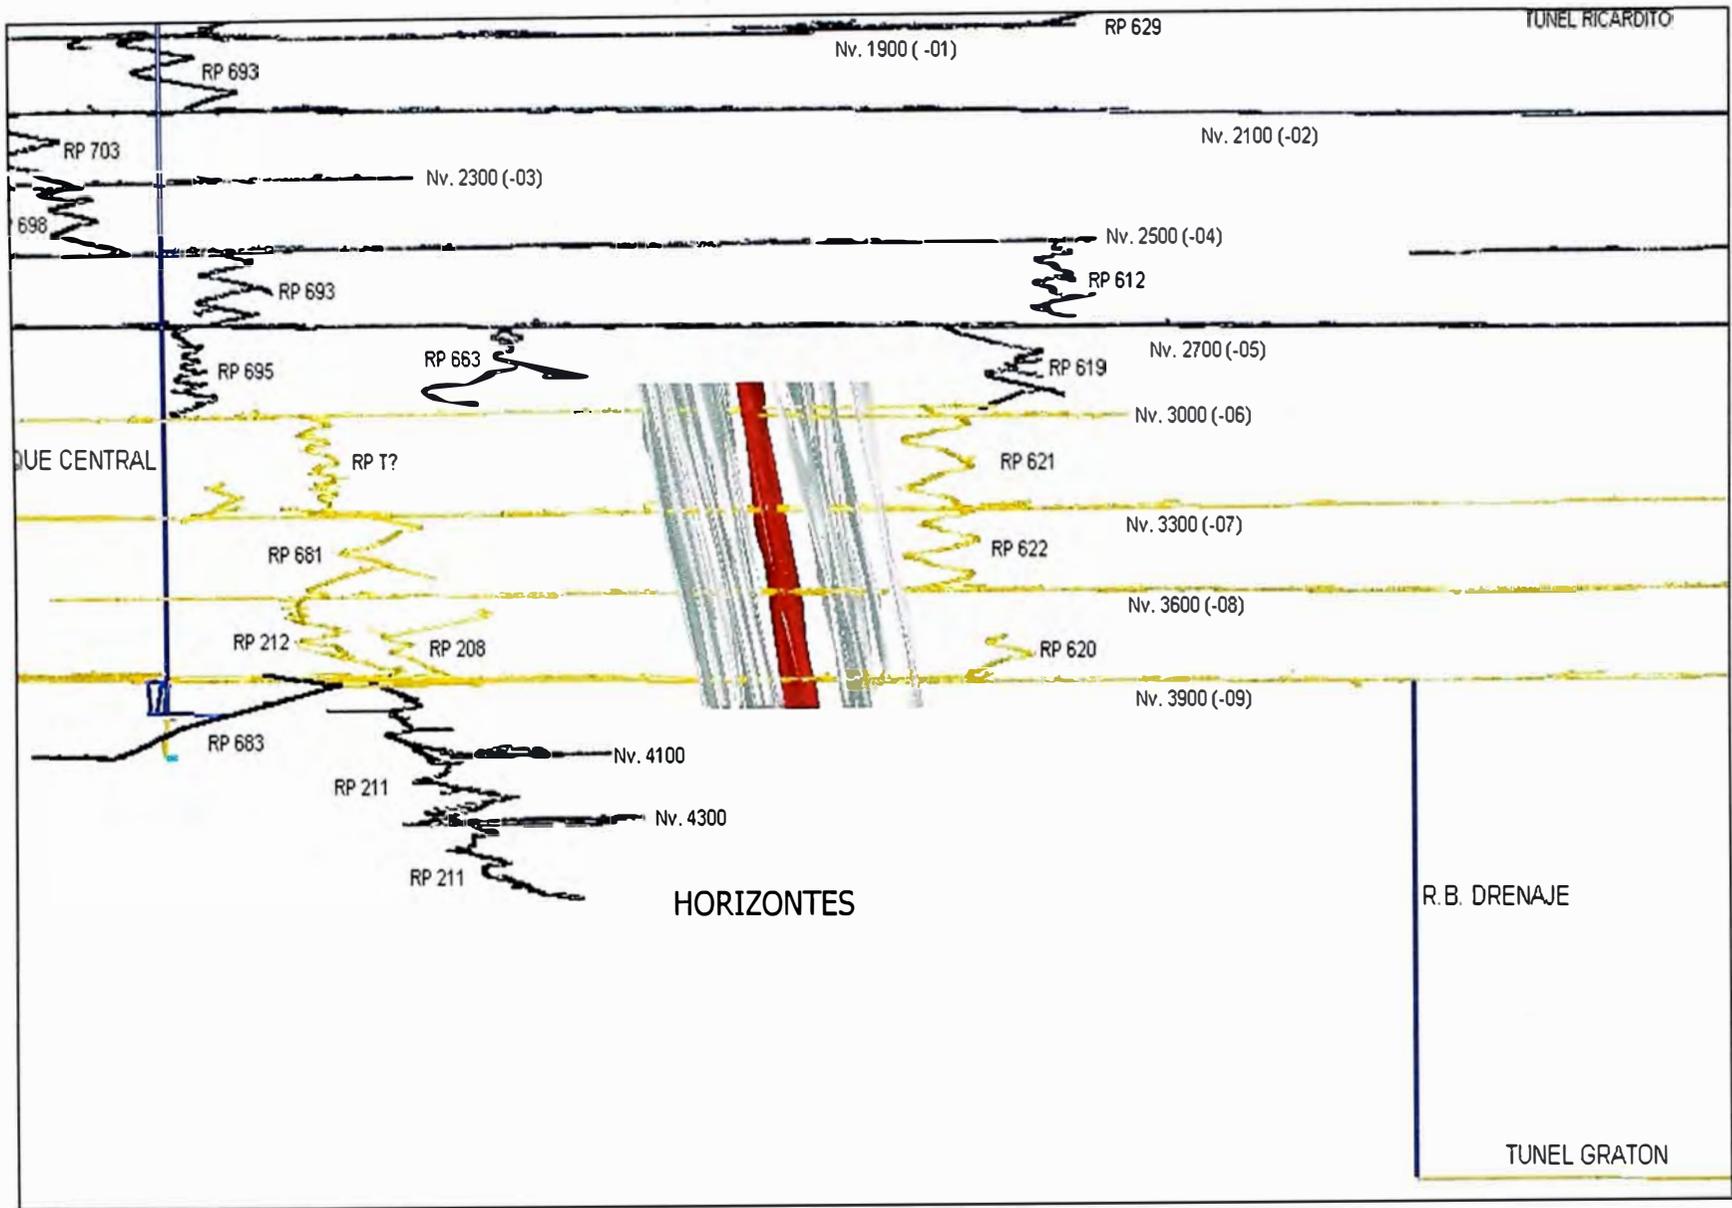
PLANO EN SECCION DE LA UBICACIÓN DE LA ZONA HORIZONTES
